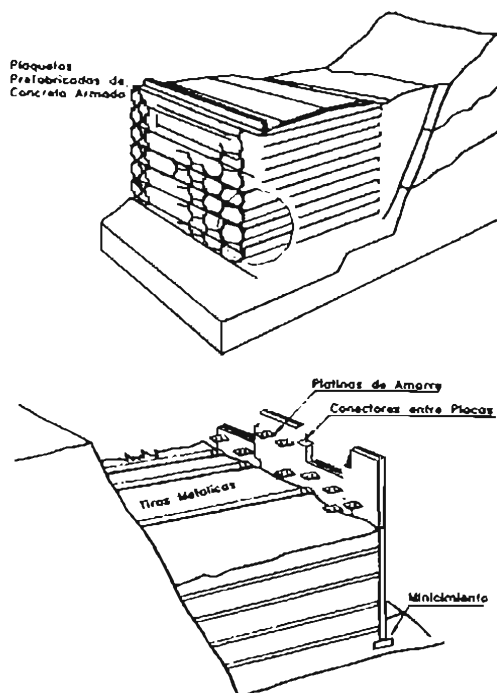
Muro de tierra armada con refuerzo de tiras metálicas
